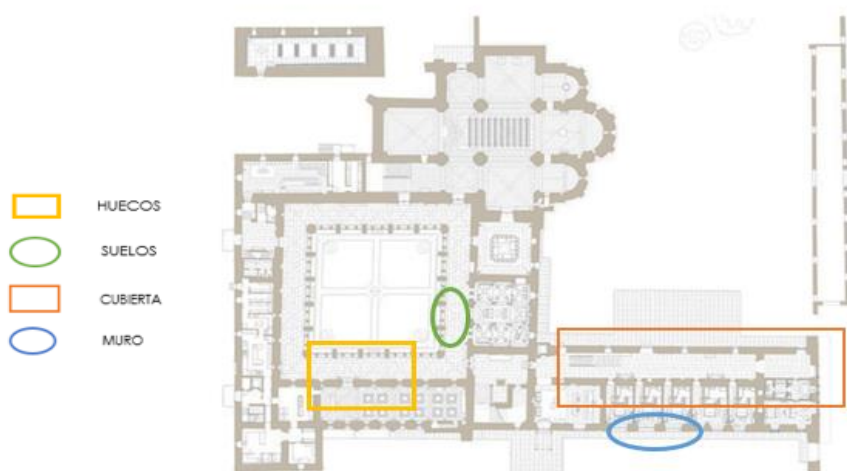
Plano de localización de los elementos a intervenir. Fuente: elaboración propia
